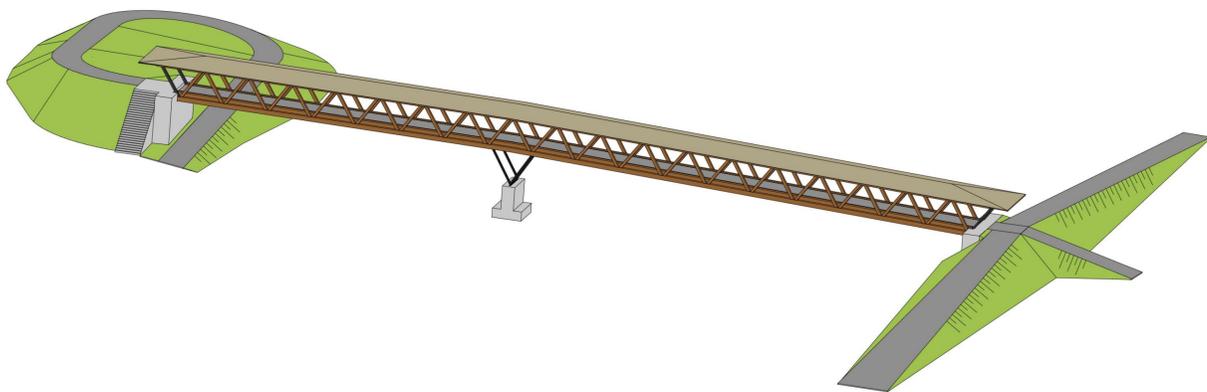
Dreidimensionale Darstellung der Fachwerkbrücke
